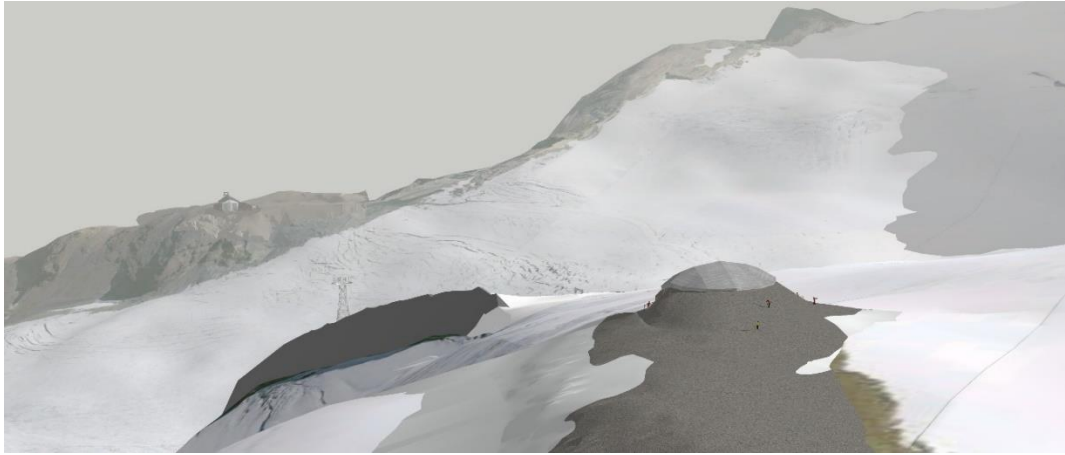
Gare amont (3600 m) et Pylône de 27 m
